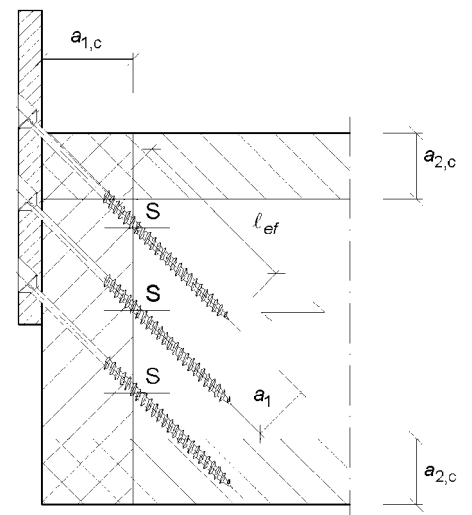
Definition der Mindestabstände bei einer Anordnung von Schrauben unter 45° zur Faserrichtung. S: Schwerpunkt des Schraubenteils im Holz
